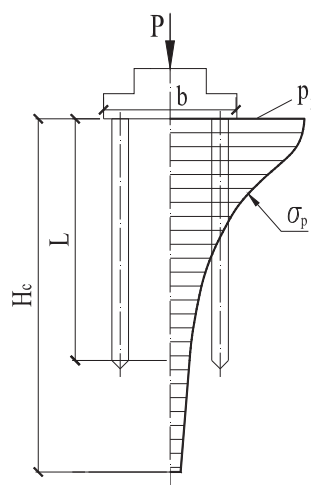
Схема распределения вертикальных напряжений под подошвой фундаментной плиты при $H_c > L$
